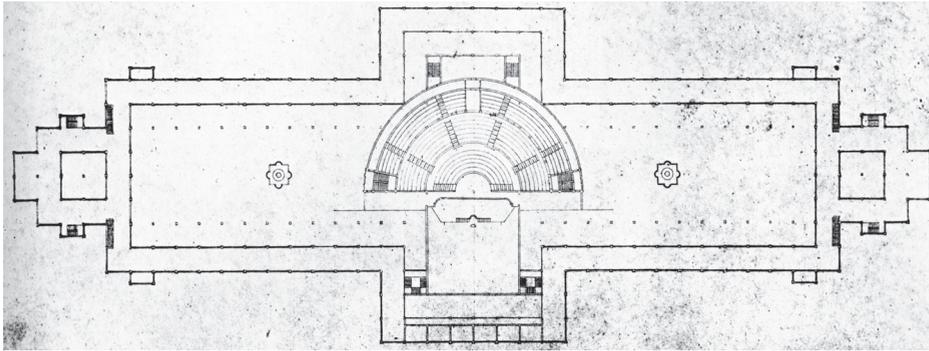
Projekt B. Grundriss mit erweitertem Orchesterraum<sup>31</sup>
